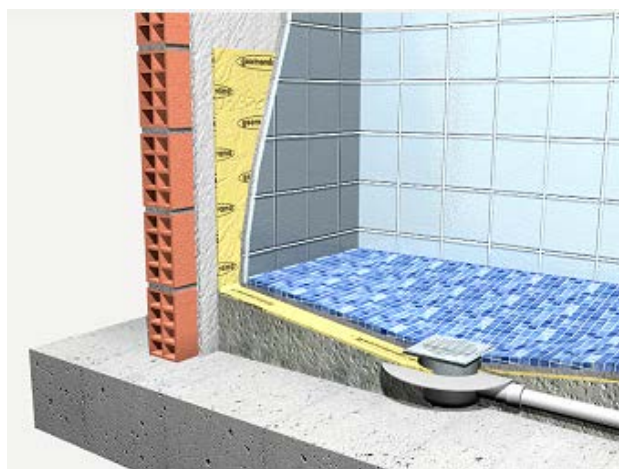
Impermeabilização sob revestimento em locais húmidos [37]
